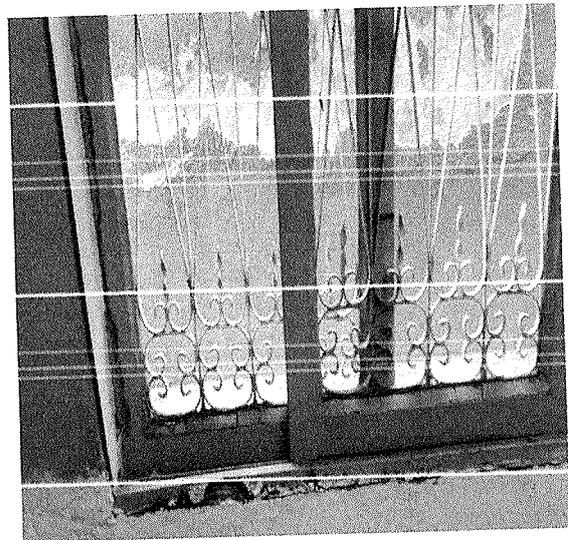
Janela em mau estado de conservação – Sala de arquivos 2.
